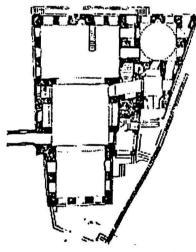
صعدة، مسجد الراري. مسقط أفقي (عن الملاع)
